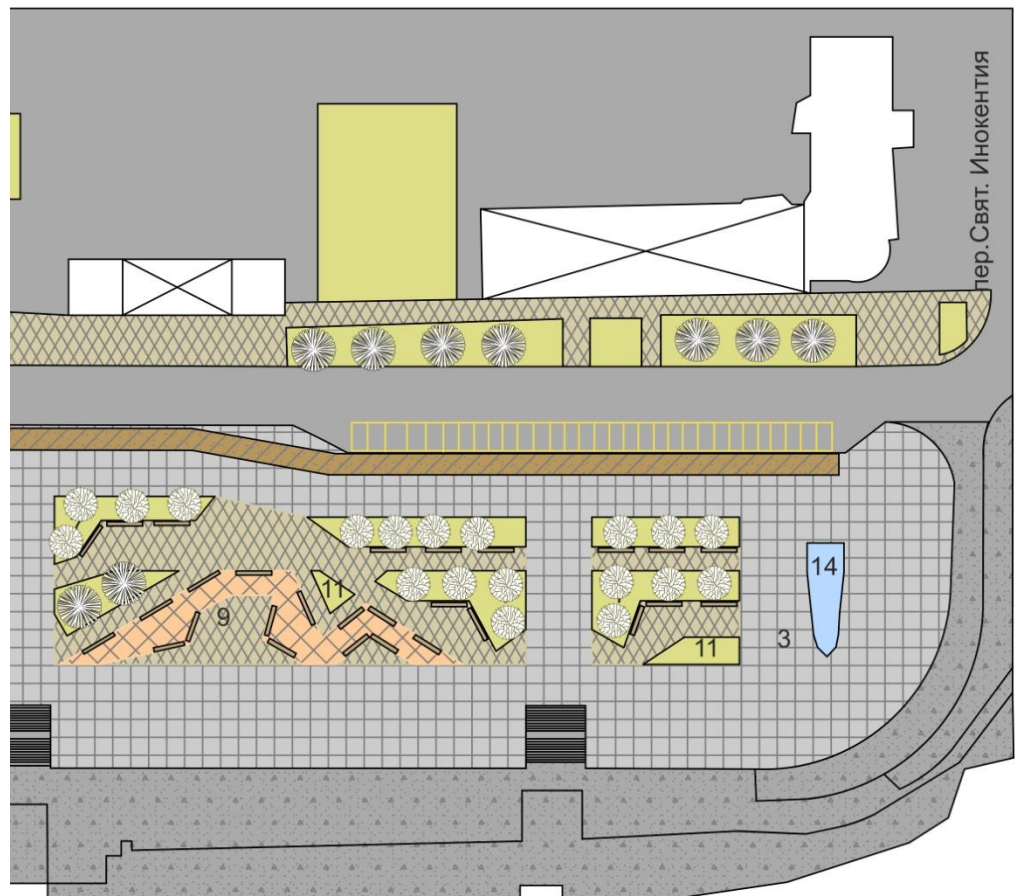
Фрагмент генплана набережной р. Амур. Зона ветра
